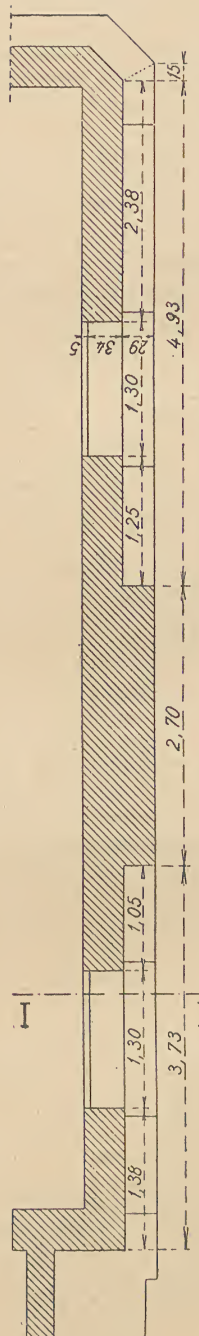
Plan du balcon du 4° étage, partie de droite sur l'impasse.
